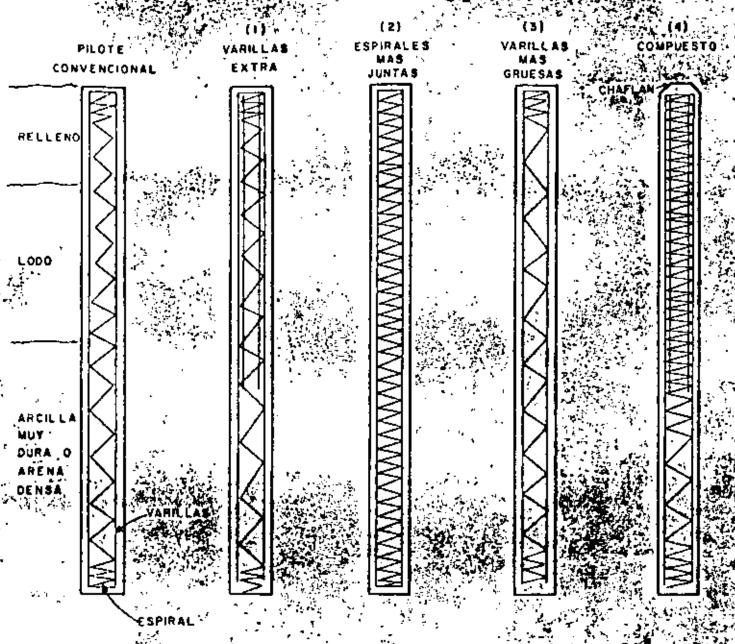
REFUERZO SUGERIDO EN LOS PILOTES DE CONCRETO
